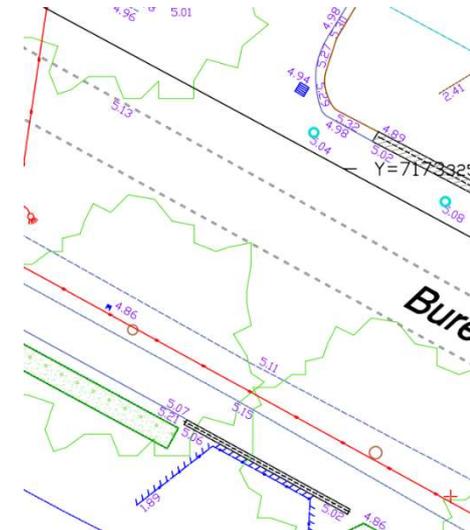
Fond de plan topo RD775 (Quarta)
